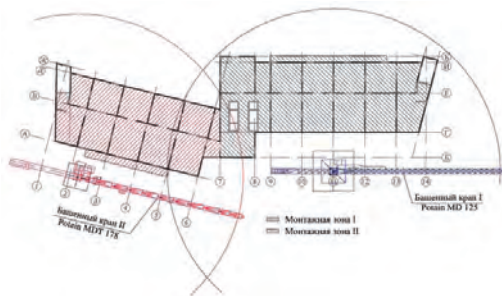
Пример деления развитого в плане здания на две монтажные зоны
